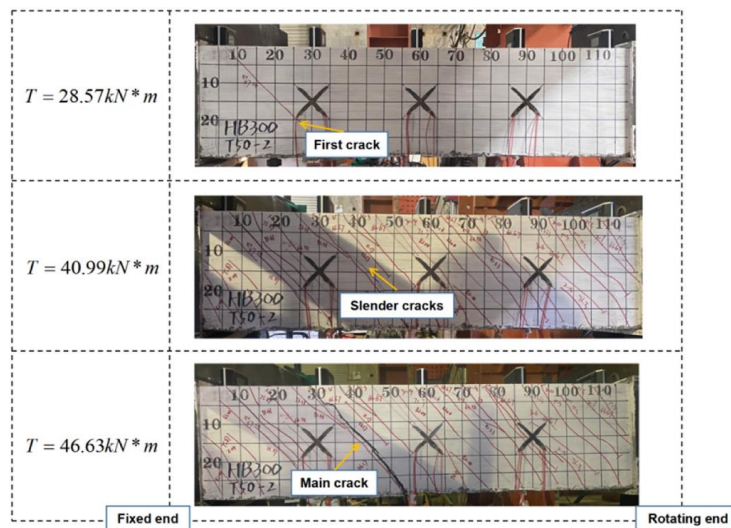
Comportamentos de fissuração da Viga HB300T50-2 [3]
